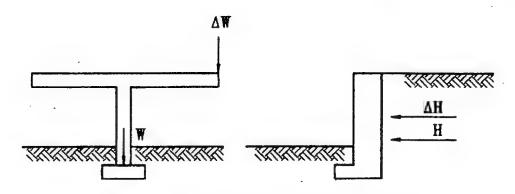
الأجزاء من مساحة الأساسات التي تعمل في نقل الأحمال من الأساس إلى التربة
